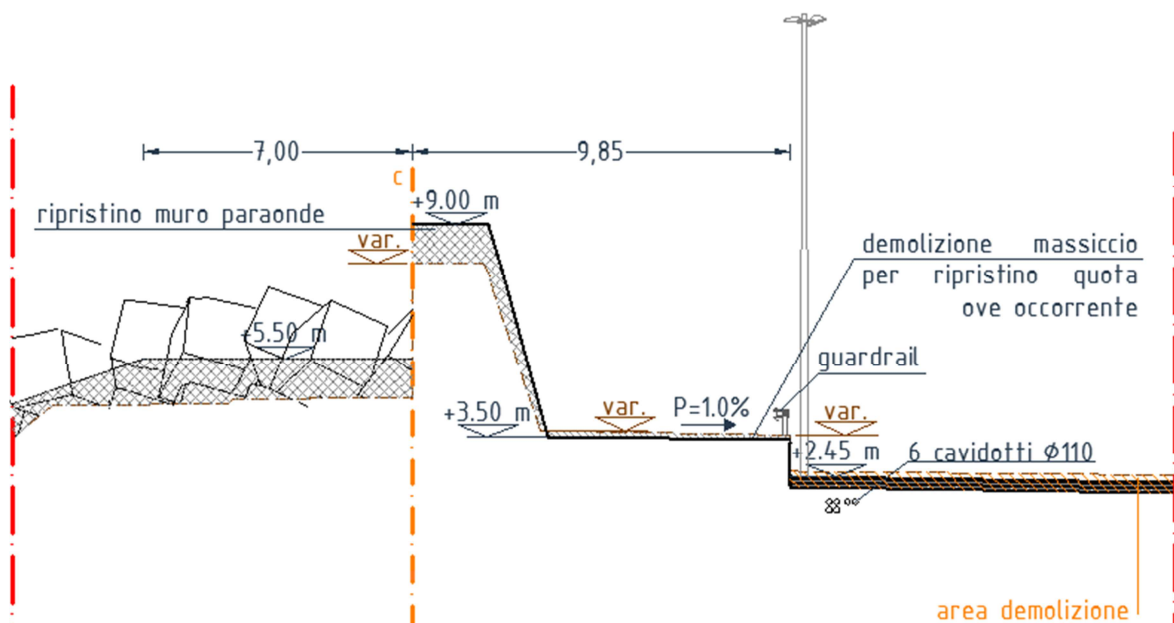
Sezione intervento di rifiorimento, massiccio e muro paraonde
